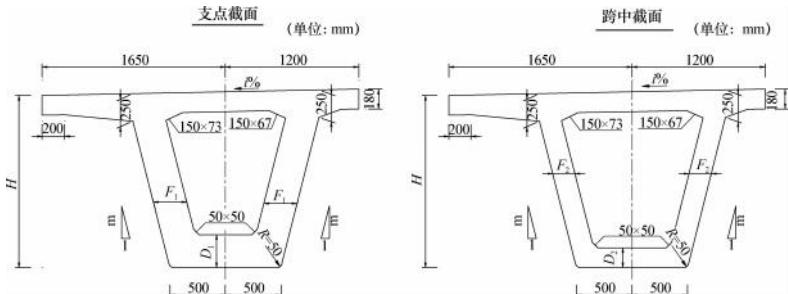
预应力混凝土箱梁断面 (mm)
